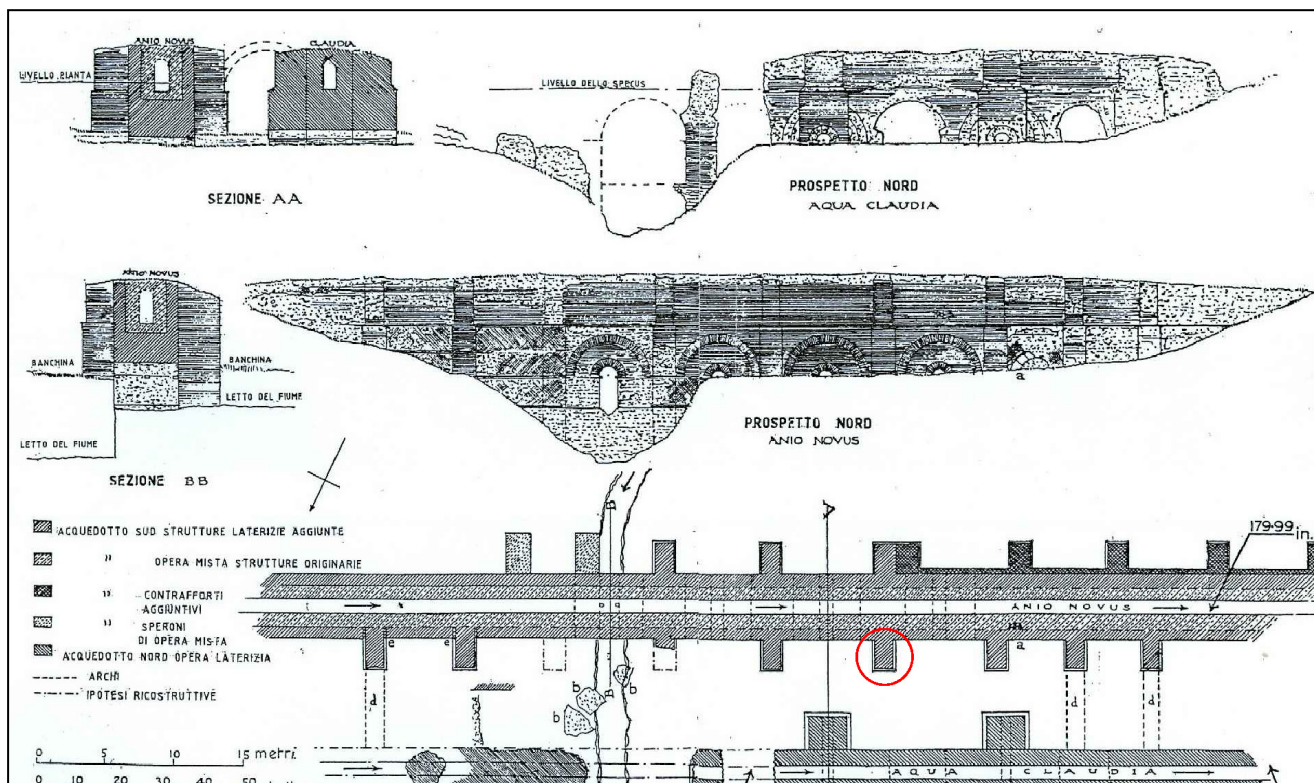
Ponte Diruto: pianta, prospetto e sezione (da Ashby 1991).
